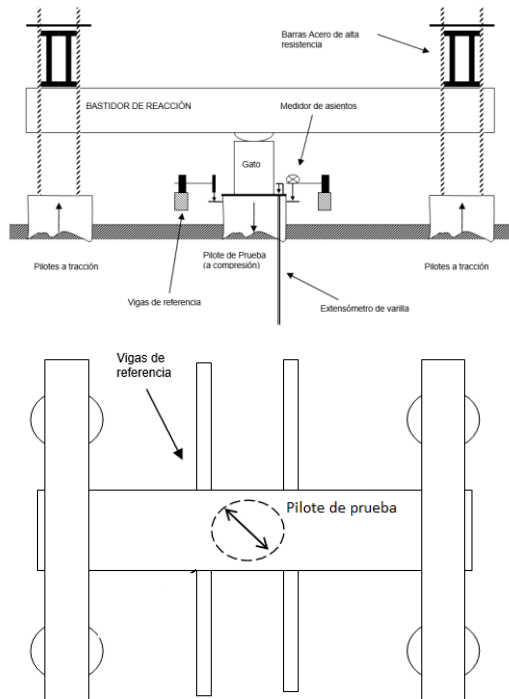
Croquis de disposición de una prueba estática vertical a compresión, en alzado y en planta (fuente: elaboración propia)
